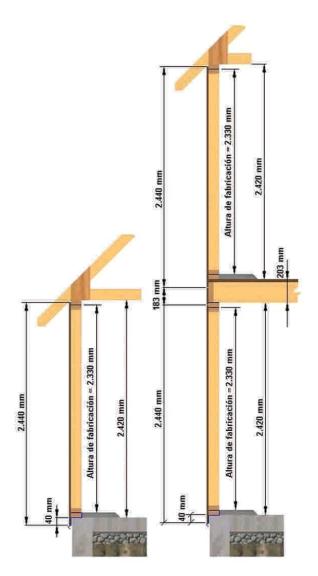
76: Altura de fabricación de tabiques con madera cepillada sobre plataforma de hormigón para el caso de viviendas de 1 ó 2 pisos, considerando solera basal de montaje, sobrelosa afinada sobre el radier y loseta liviana acústica en 2º piso; ambas de 40 a 50 mm de espesor.
